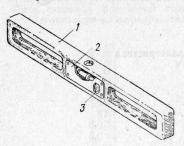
1 — корпус; 2 — ампула, 3 — винт; 4 — крышка
